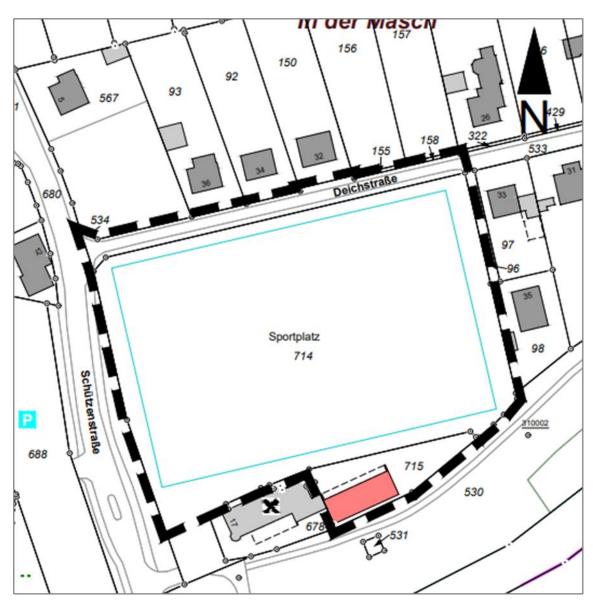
Ausschnitt Lageplan (Stadt Löhne, 2021) zur Abgrenzung des Plangebietes, nicht maßstäblich,
